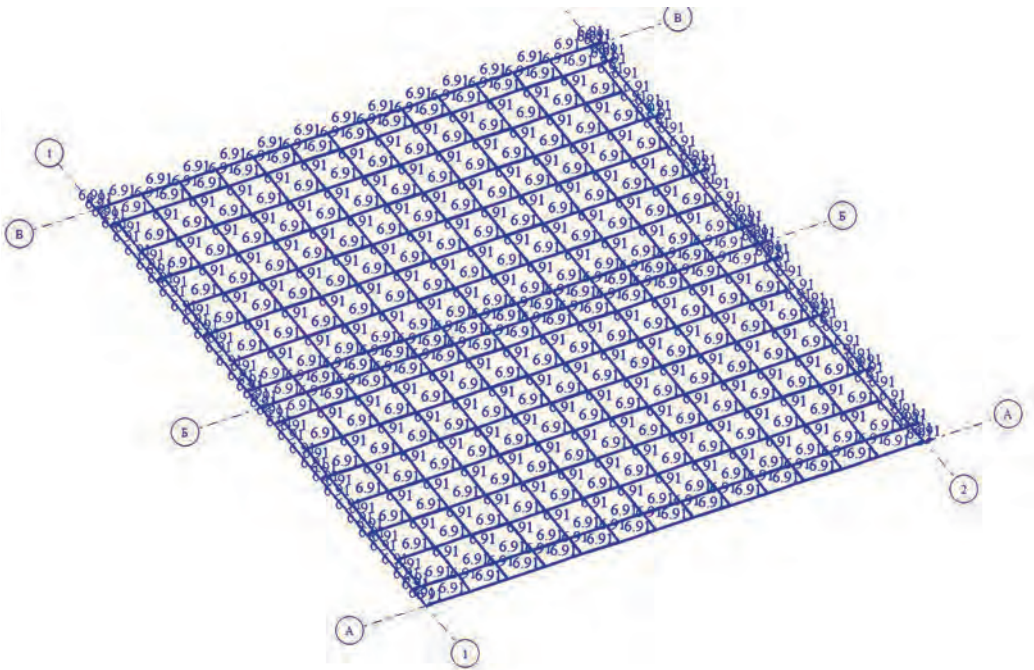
Фрагмент перекрытия типового этажа с температурной нагрузкой в холодное время года.
